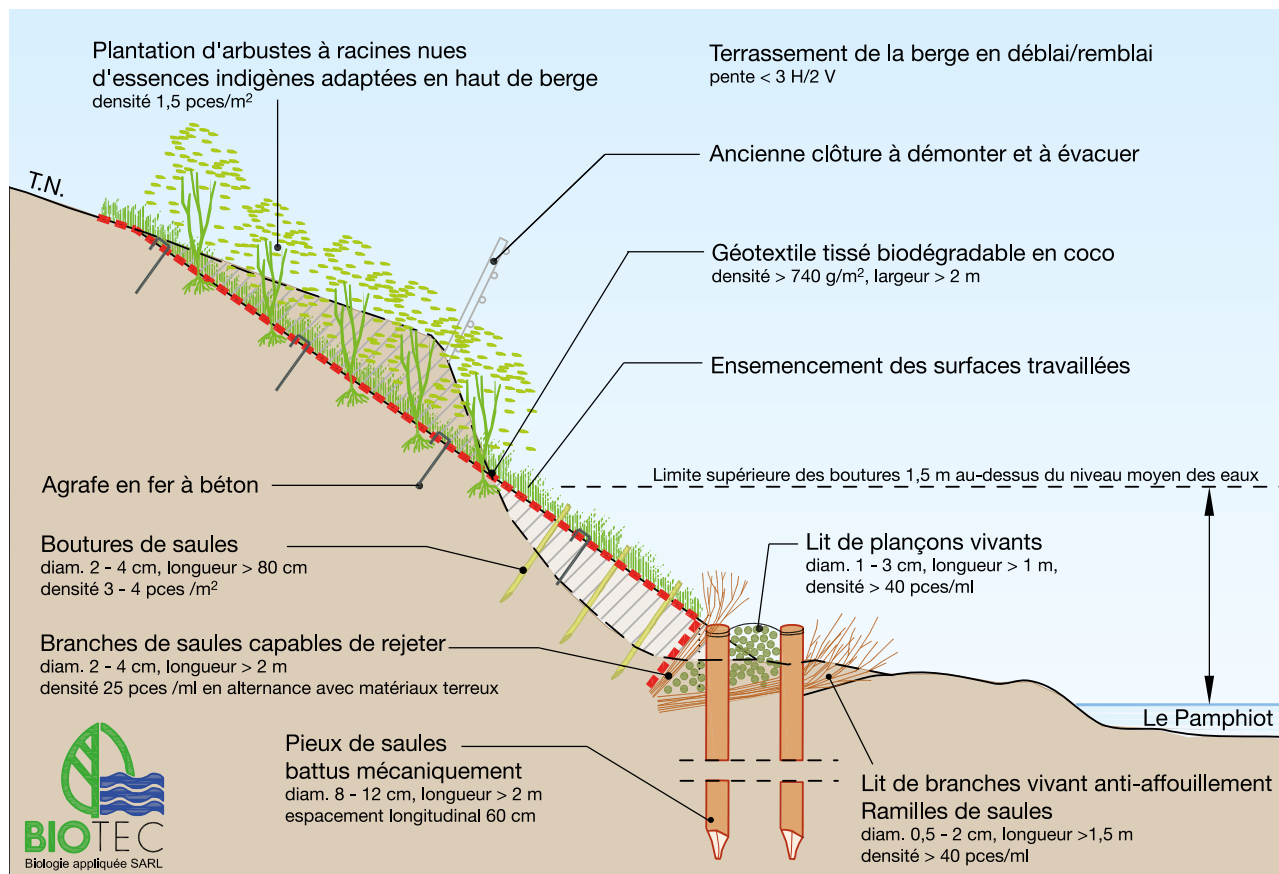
Coupe transversale de la zone aval (source : BIOTEC).
